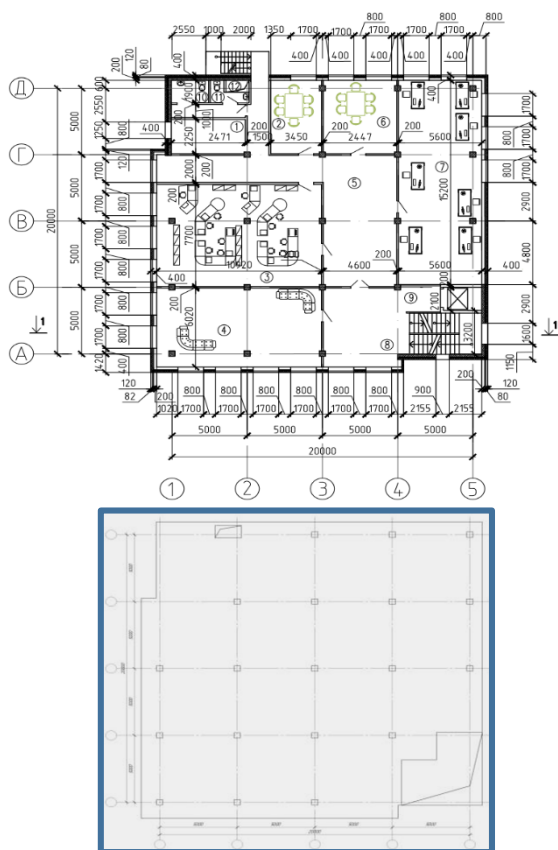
Планы типового этажа и его плиты перекрытия как объекта исследования
